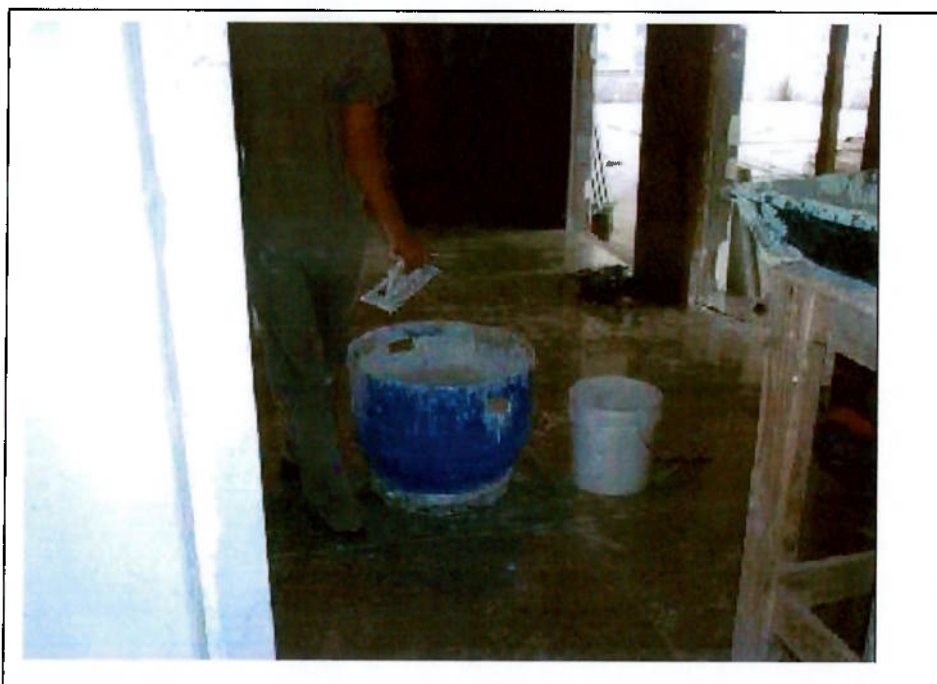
Colaboradores trabalhando nos pavimentos próximos da portas dos elevadores
